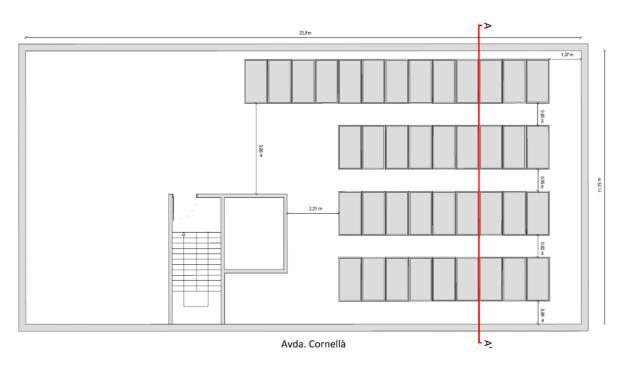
Disposición de los paneles en la cubierta (fuente: propia).
